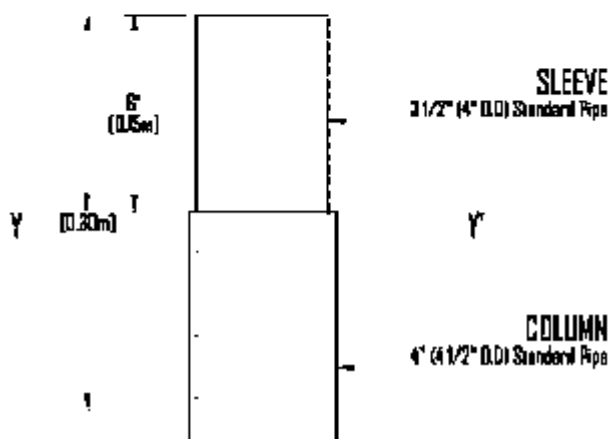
Detalle del sleeve (manga) dentro de la columna, de la sección inferior de una escalera, que recibirá la sección de arriba.
